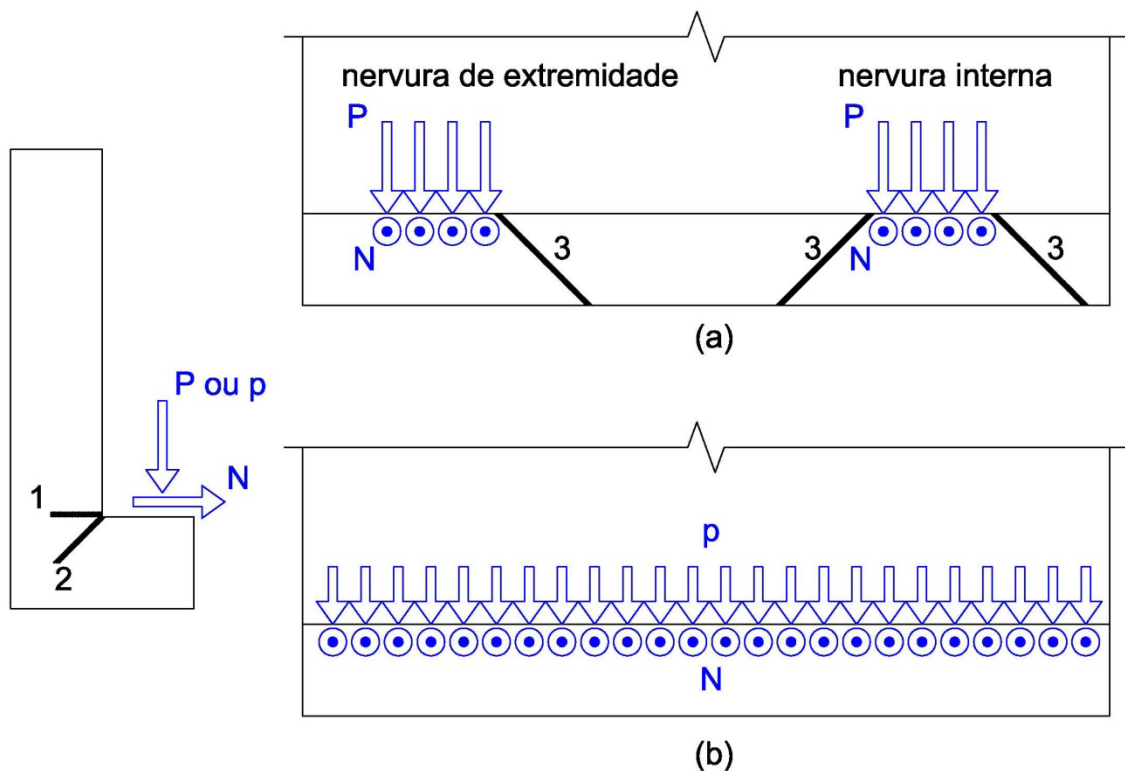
Efeitos das cargas aplicadas na aba de vigas de seção “L”: (a) laje TT; (b) laje alveolar; zonas 1, 2 e 3 são fissuras potenciais [adaptado de El Debs (2000) e Raths (1984)].
